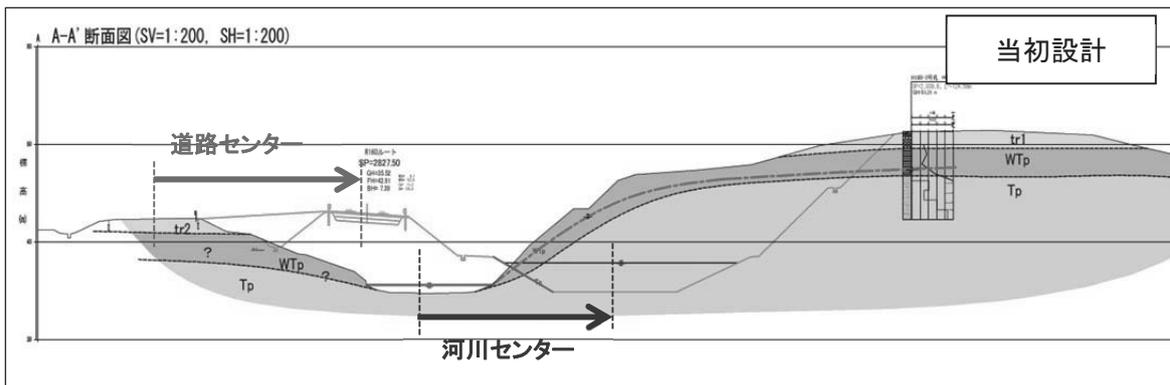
当初設計での新道計画・河道切替え計画断面図 (A-A'断面)
